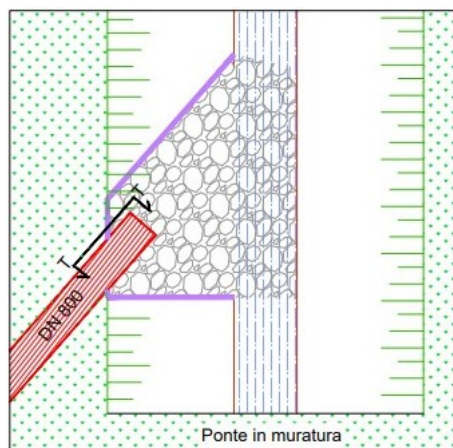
Planimetria del collegamento con il fosso Duca degli Abruzzi
